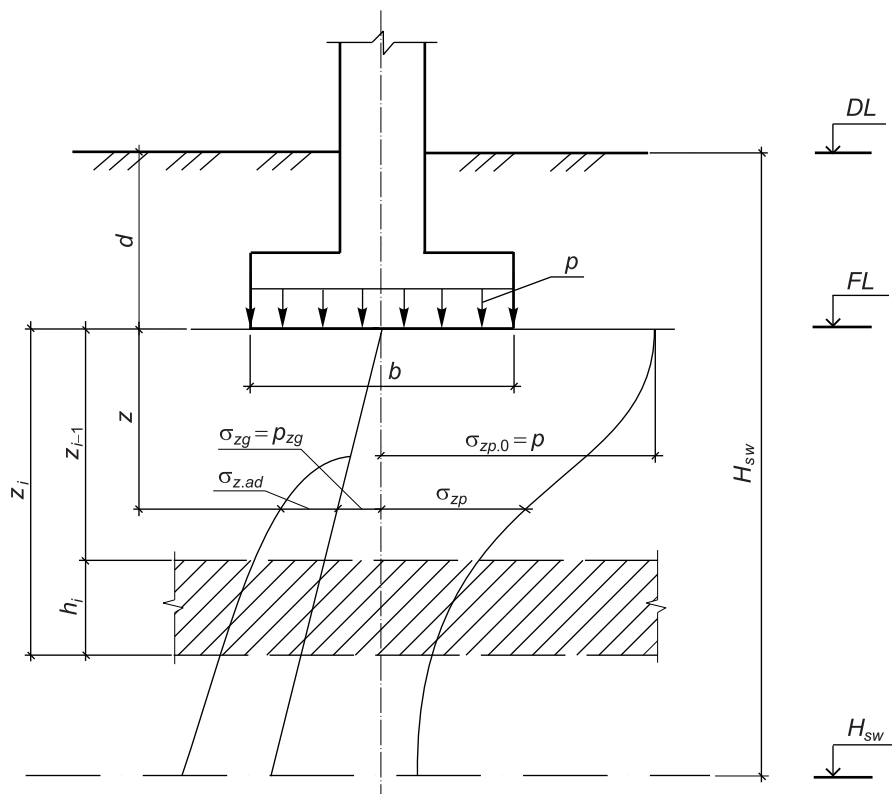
Схема к расчету подъема основания при набухании грунта
